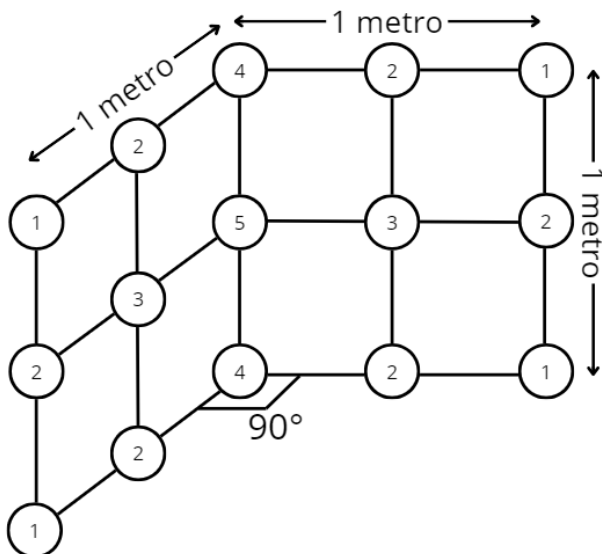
Diseño esquemático de la estructura simple del atrapanieblas con soporte estructural y numeración de uniones [Elaborado por el autor].
